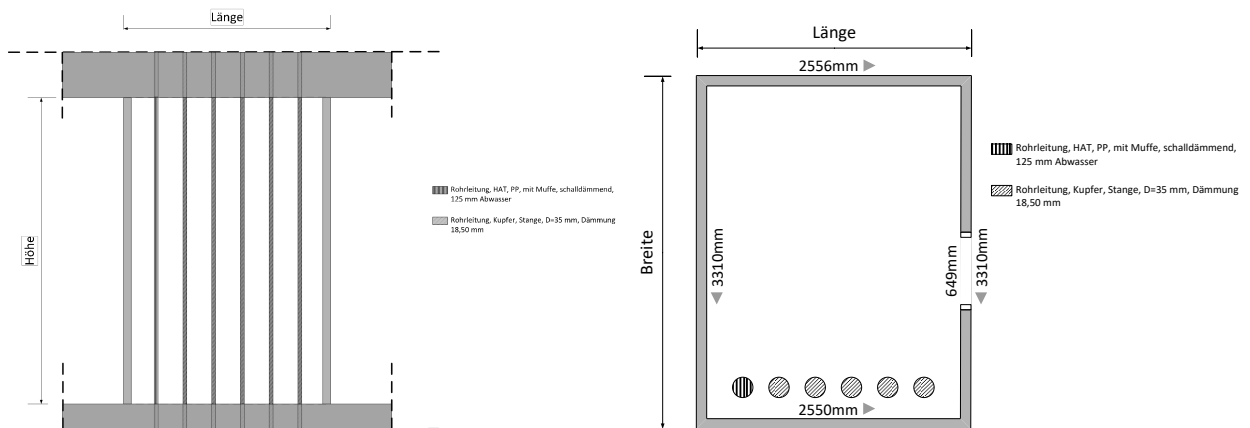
Vertikaler und Horizontaler Schnitt - Installationsschacht Wasserversorgung⁴⁷⁶
